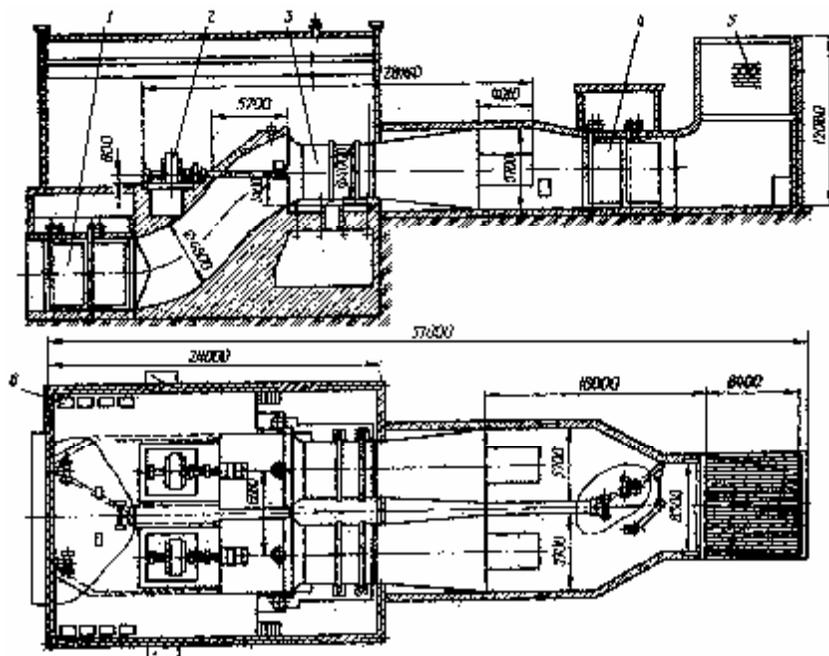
Установка с вентилятором ВВД-40, работающая в нормальном режиме на всасывание: 1 – подводящий канал; 2 – привод; 3 – вентилятор; 4 – переключающие двери в диффузоре; 5 – глушитель шума
